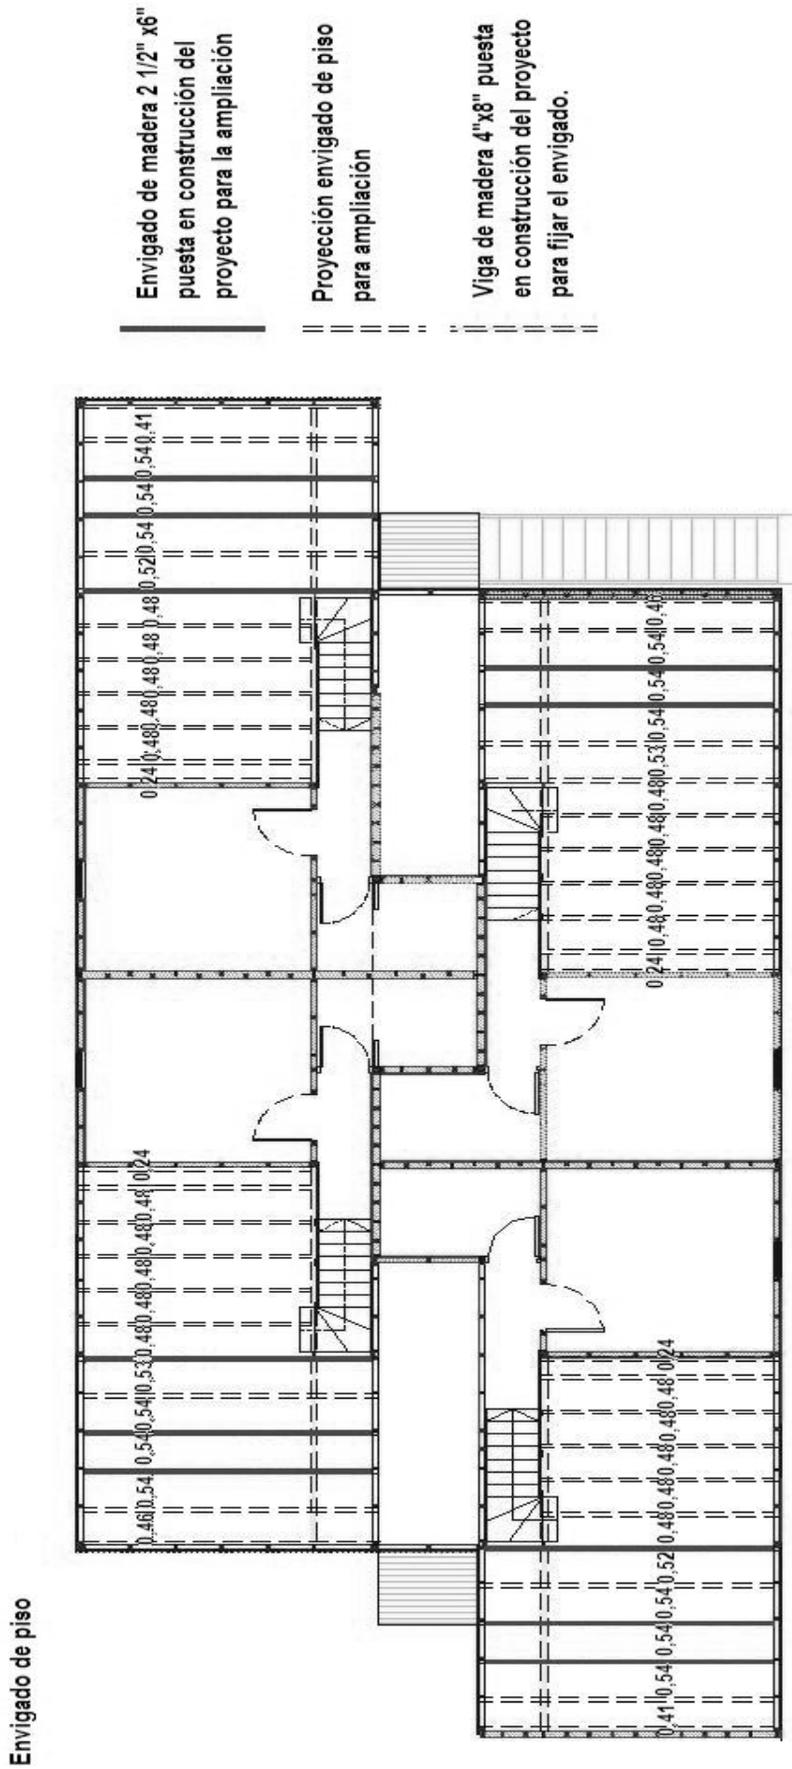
Construcción Envigado de piso para el crecimiento hacia el tercer piso de la vivienda del segundo nivel. La viga de color azul será instalada en la construcción del proyecto para que en la etapa de autoconstrucción se coloque las viguetas de piso (de color rojo en la figura) sobre ella. Fuente: Elaboración propia.
